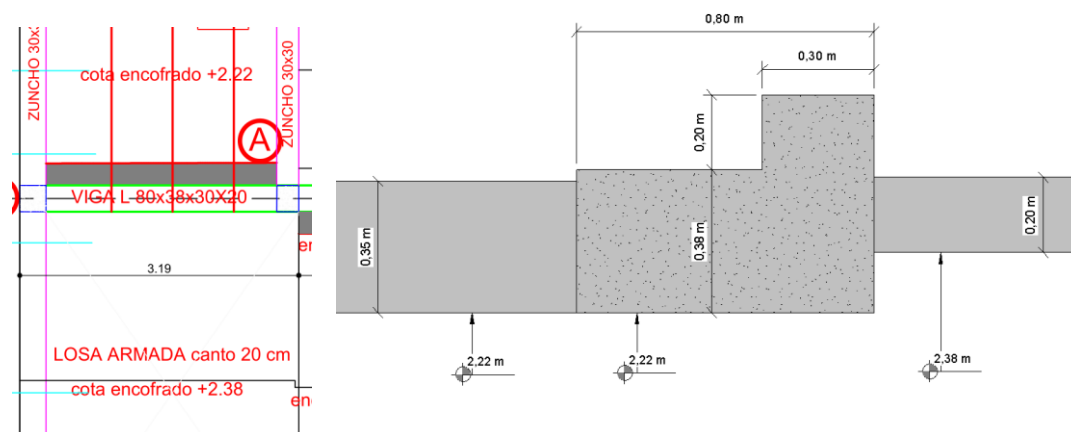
Error de dimensionado en vigas, modelado en BIM. Fuente: Proyecto original y elaboración propia.
